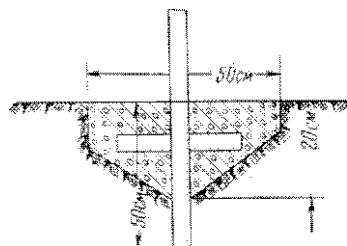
Конструкция поверхностного репера (по Н. Н. Фролову)
